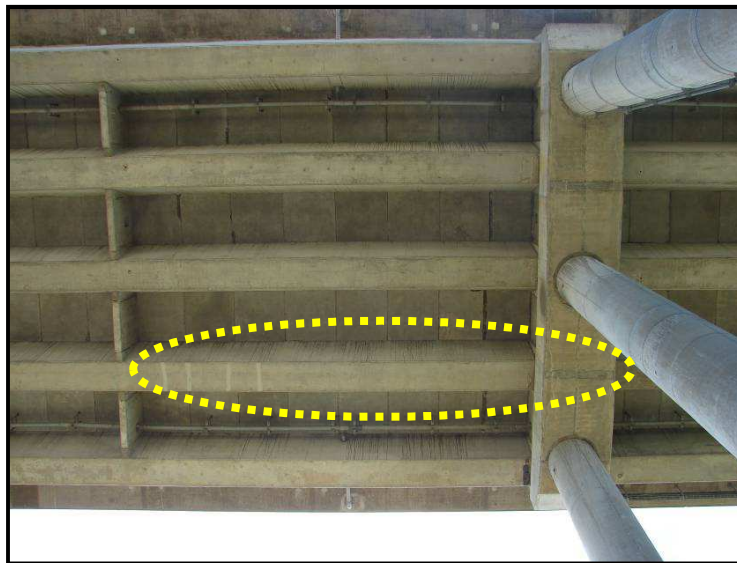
Fisuras en viga entre ejes de pilas 45 y 46-Aguas arriba-Viaducto de Acceso Oeste
